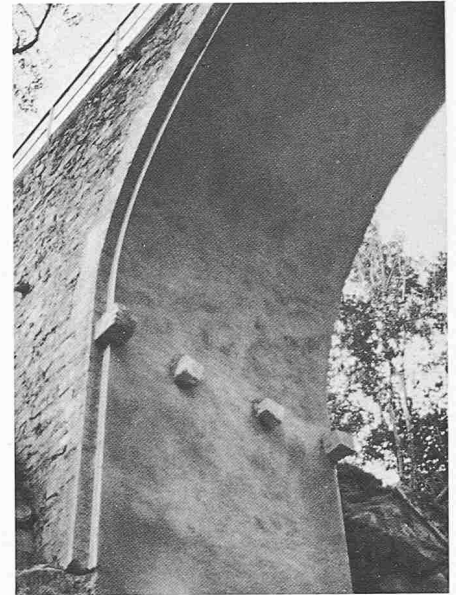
Mit Spritzbeton verstärkte Brücke aus Natursteinmauerwerk
